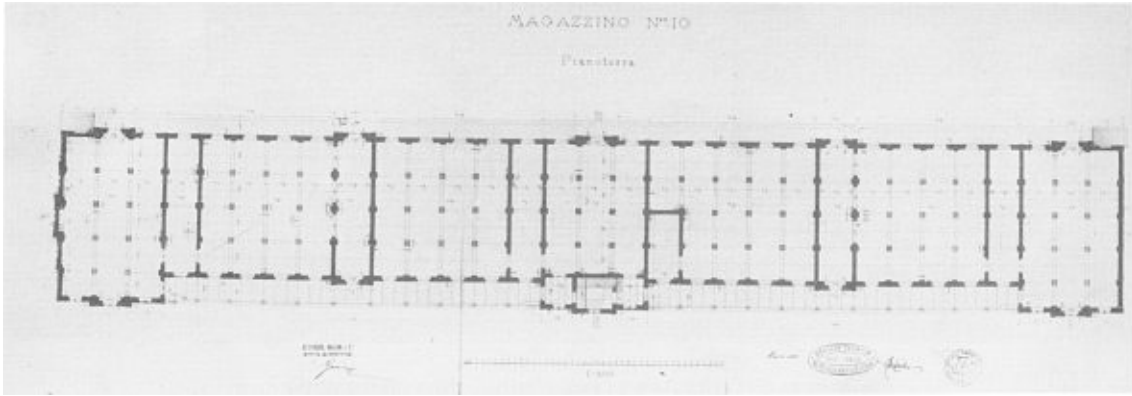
Lagerhaus 10, Grundriss
